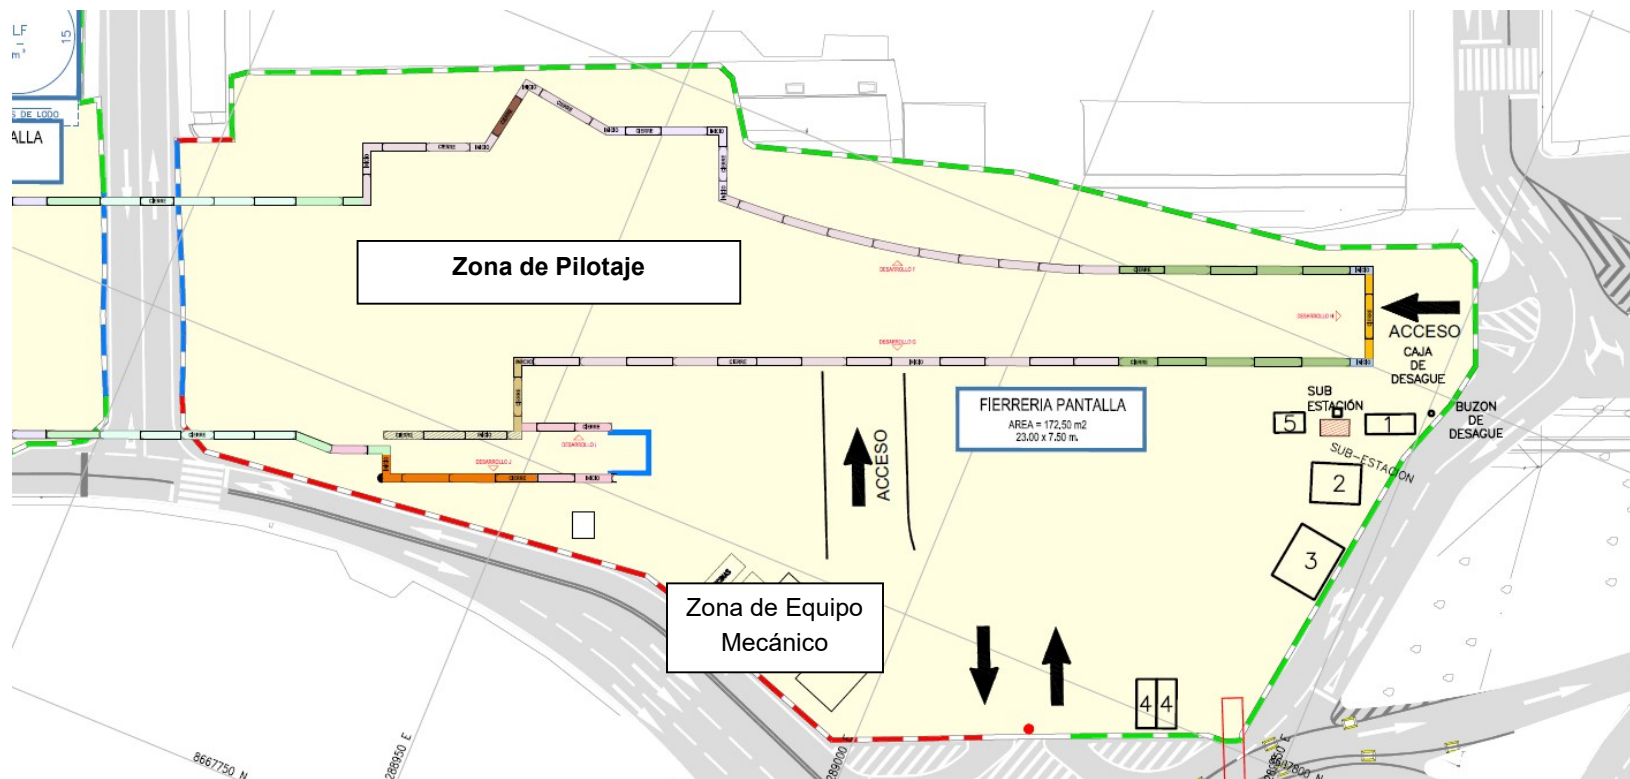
Parte 2: Layout para ejecución de pilotes, zona de herrería, zona de equipos, zona de trabajo
